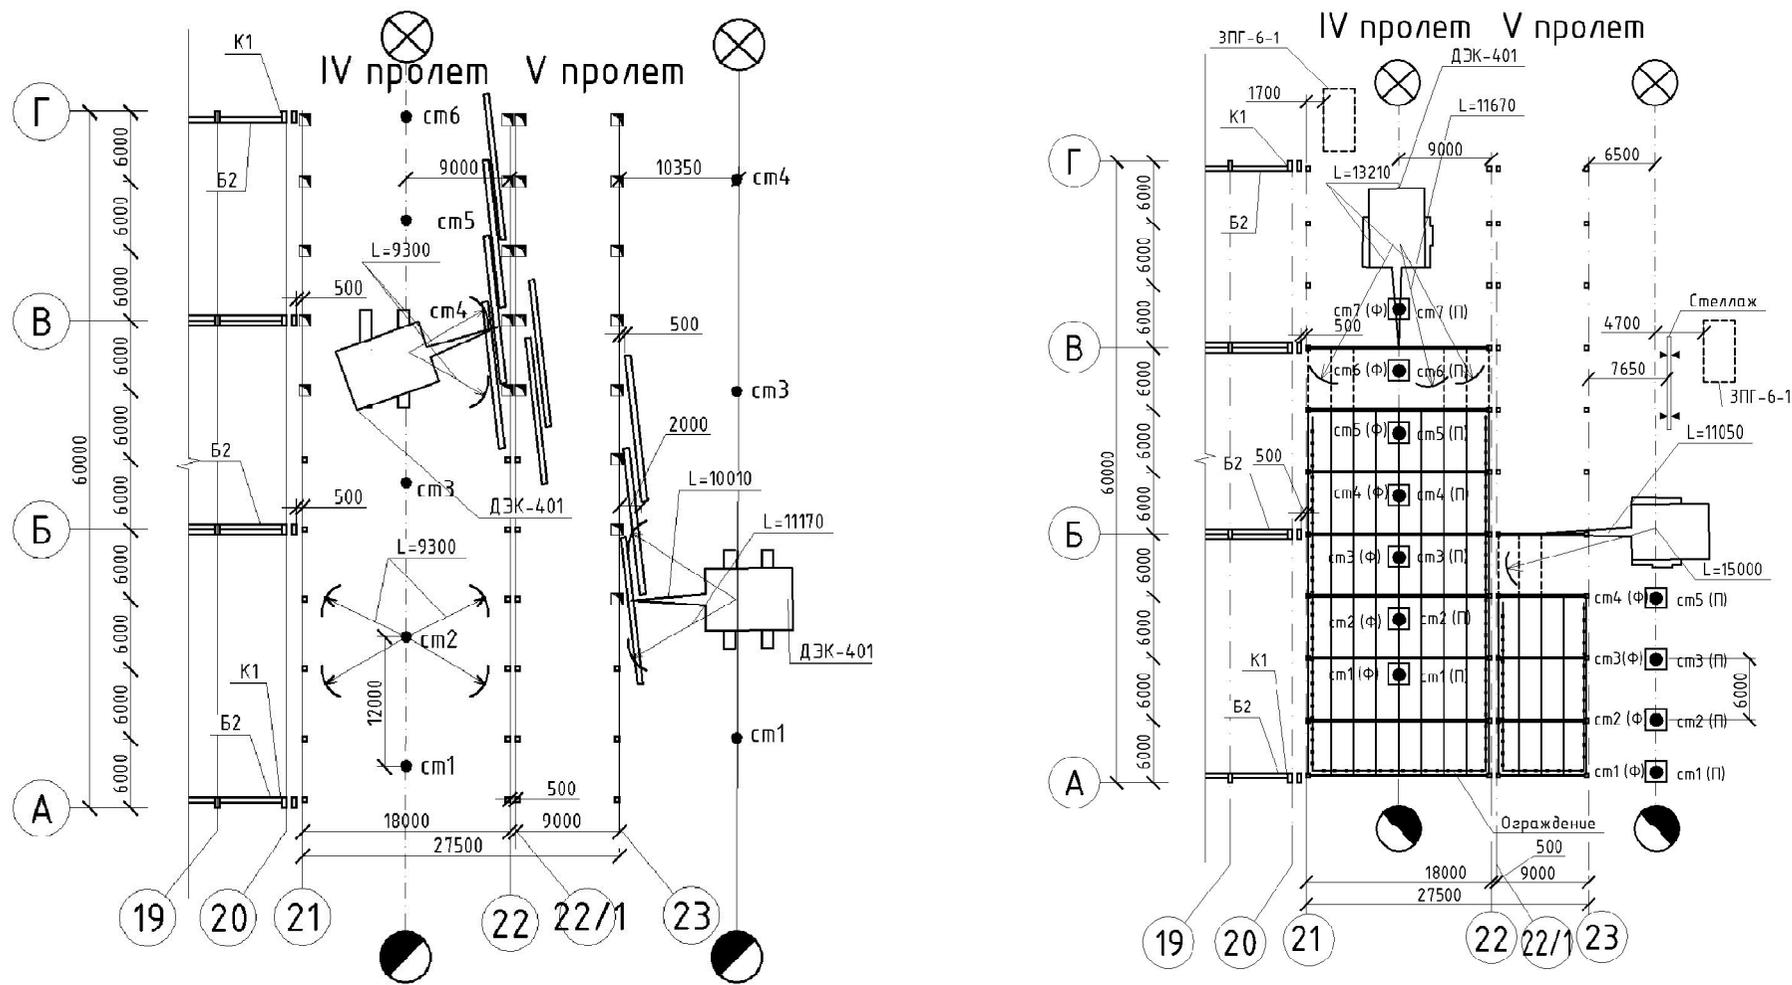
Схемы монтажа колонн и элементов покрытия (стропильных ферм и плит) каркаса второй очереди строительства в пролетах А-Г (21-23) комплектом монтажных кранов, выполнил Паршаков И.А. гр. ТСНК
